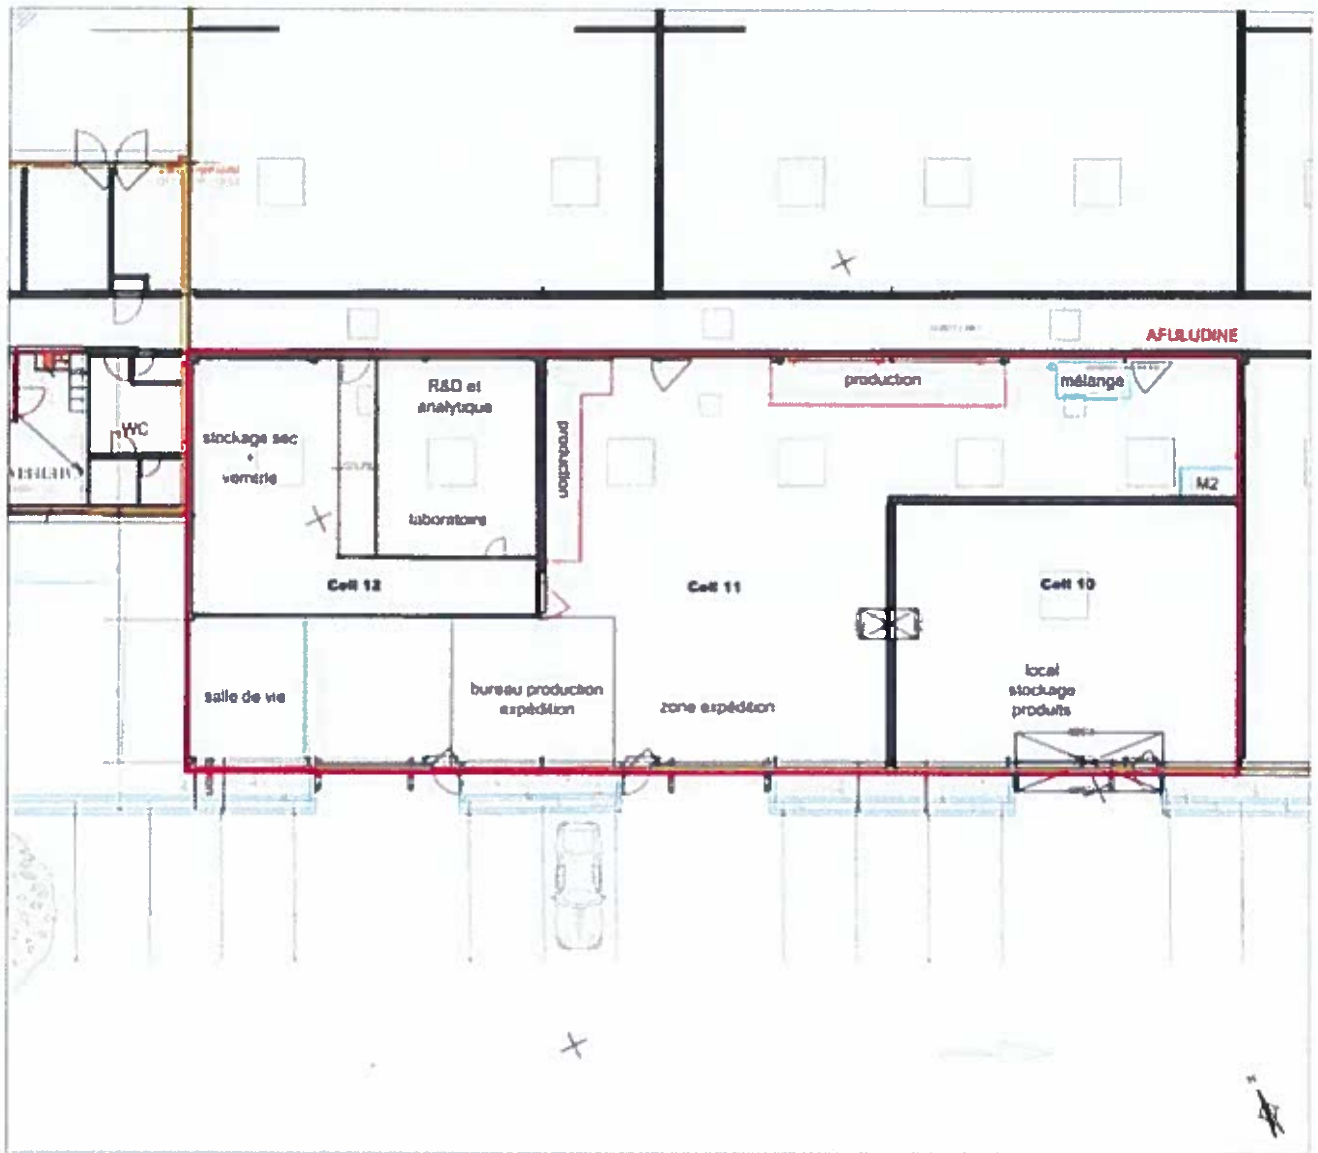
Plan d'aménagement des locaux AFULudine
